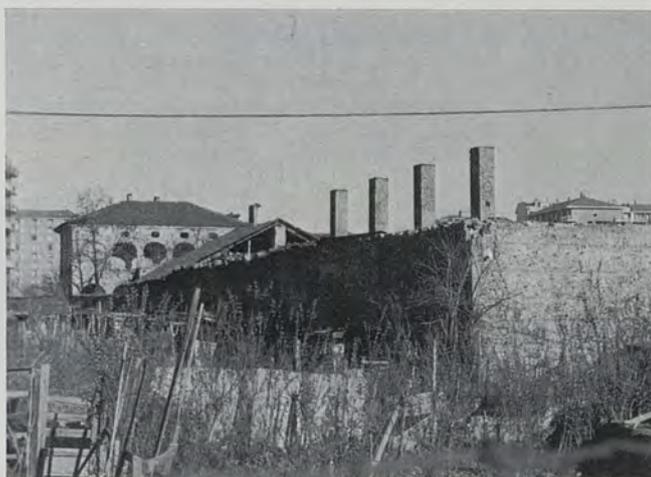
La palazzina ed i pilastri della tettoia che emergono dal muro di cinta.
